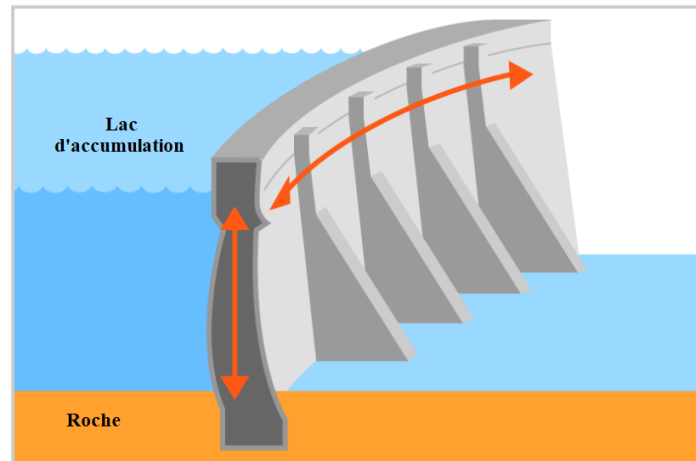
3 Coupe type d'un barrage-voûte [3]
